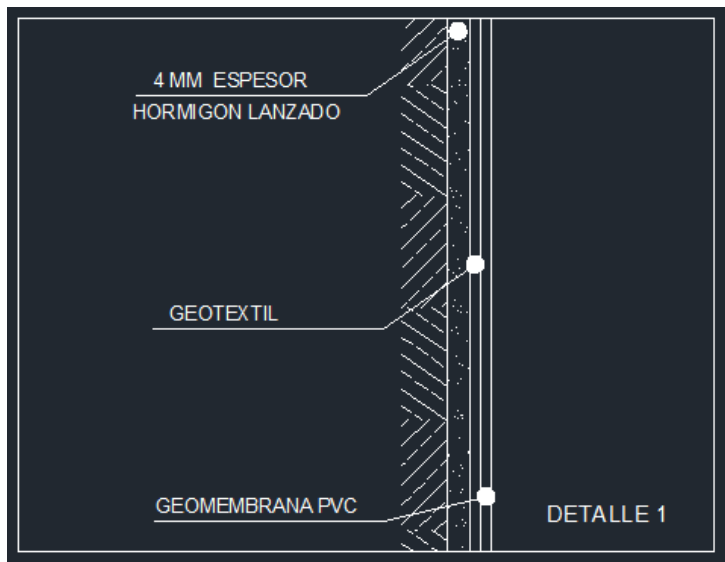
Estructura del Sistema de impermeabilización
